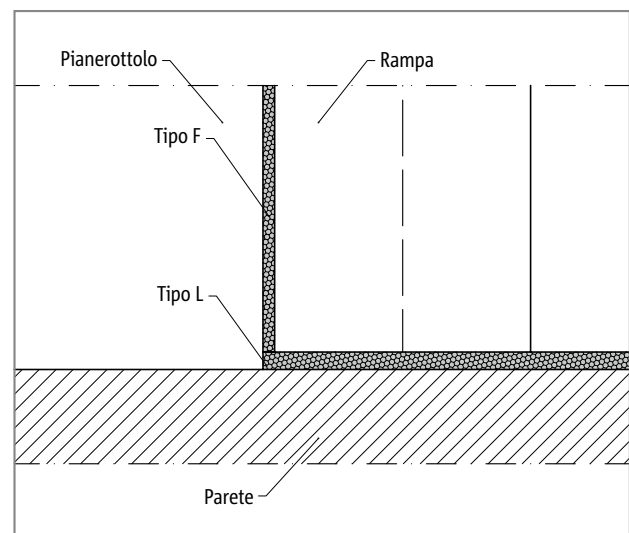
Schöck Tronsole® tipo F, Disposizione dell'elemento; dettaglio B
